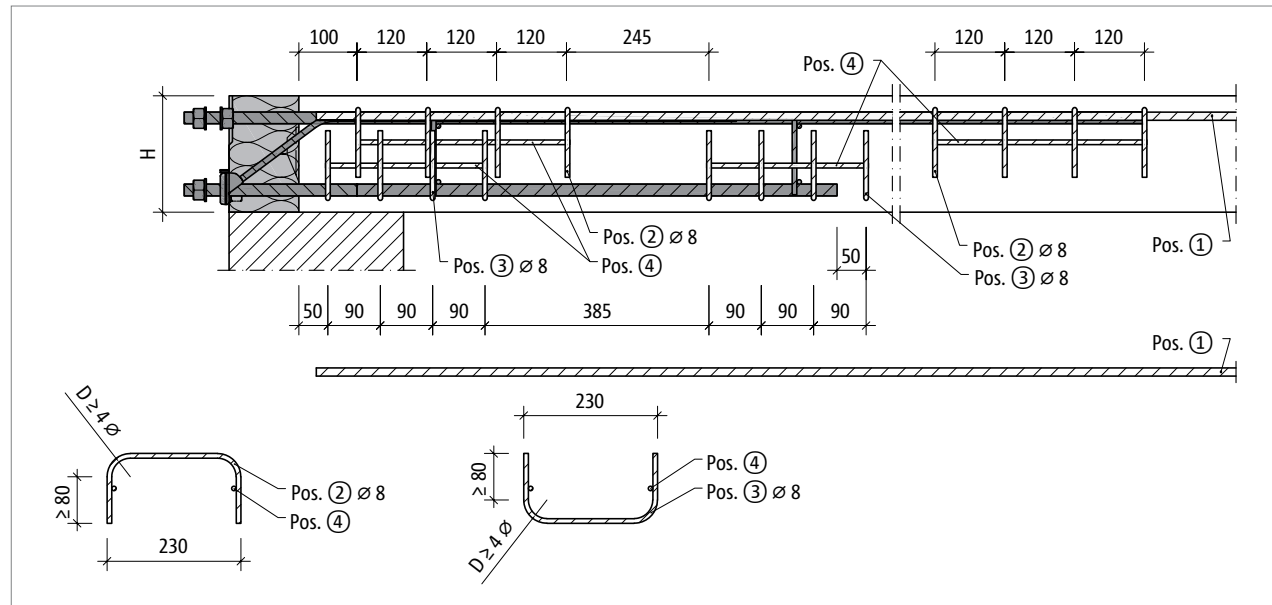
Schöck Isokorb® XT Typ SK-MM2: Bauseitige Bewehrung mit Bügel  $\varnothing$  8 mm; Schnitt
